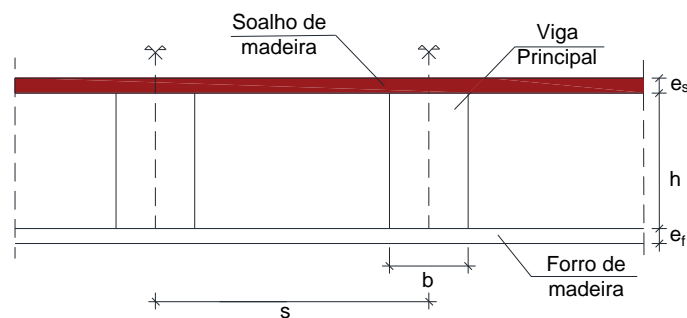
Secção média dos elementos de madeira que compõem parte do pavimento 3 (Pav. 3 – S2.3)
